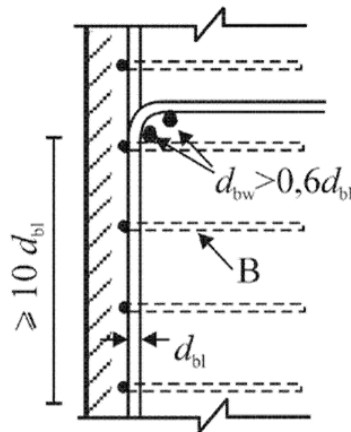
Dobragem dos varões longitudinais e colocação das armaduras transversais no interior.
